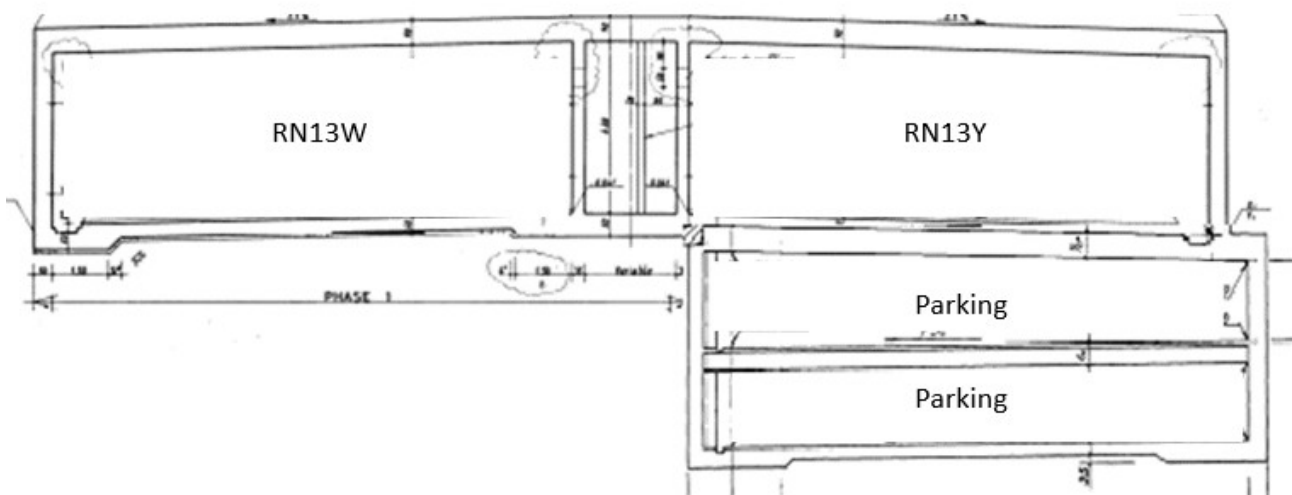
Coupe type zones 1 et 2 avec le parking souterrain
